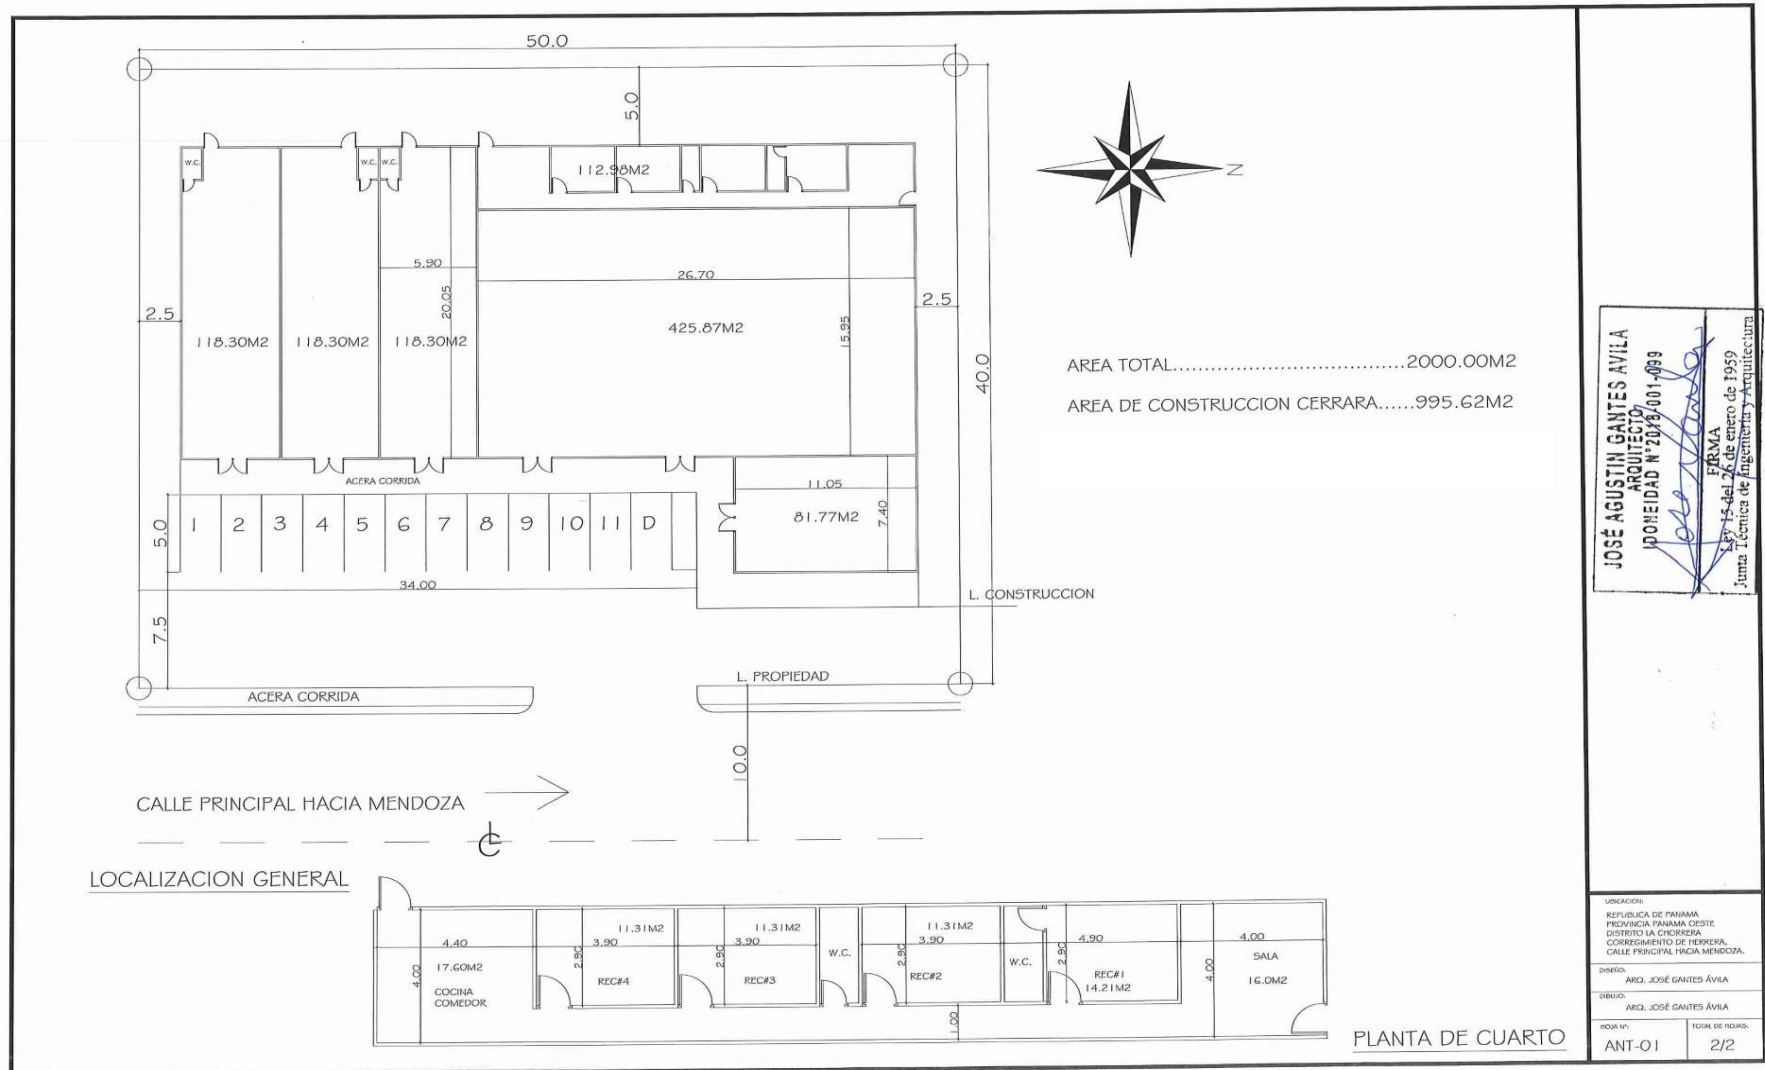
Vista el sitio donde se construiría el proyecto “Centro Comercial”.
